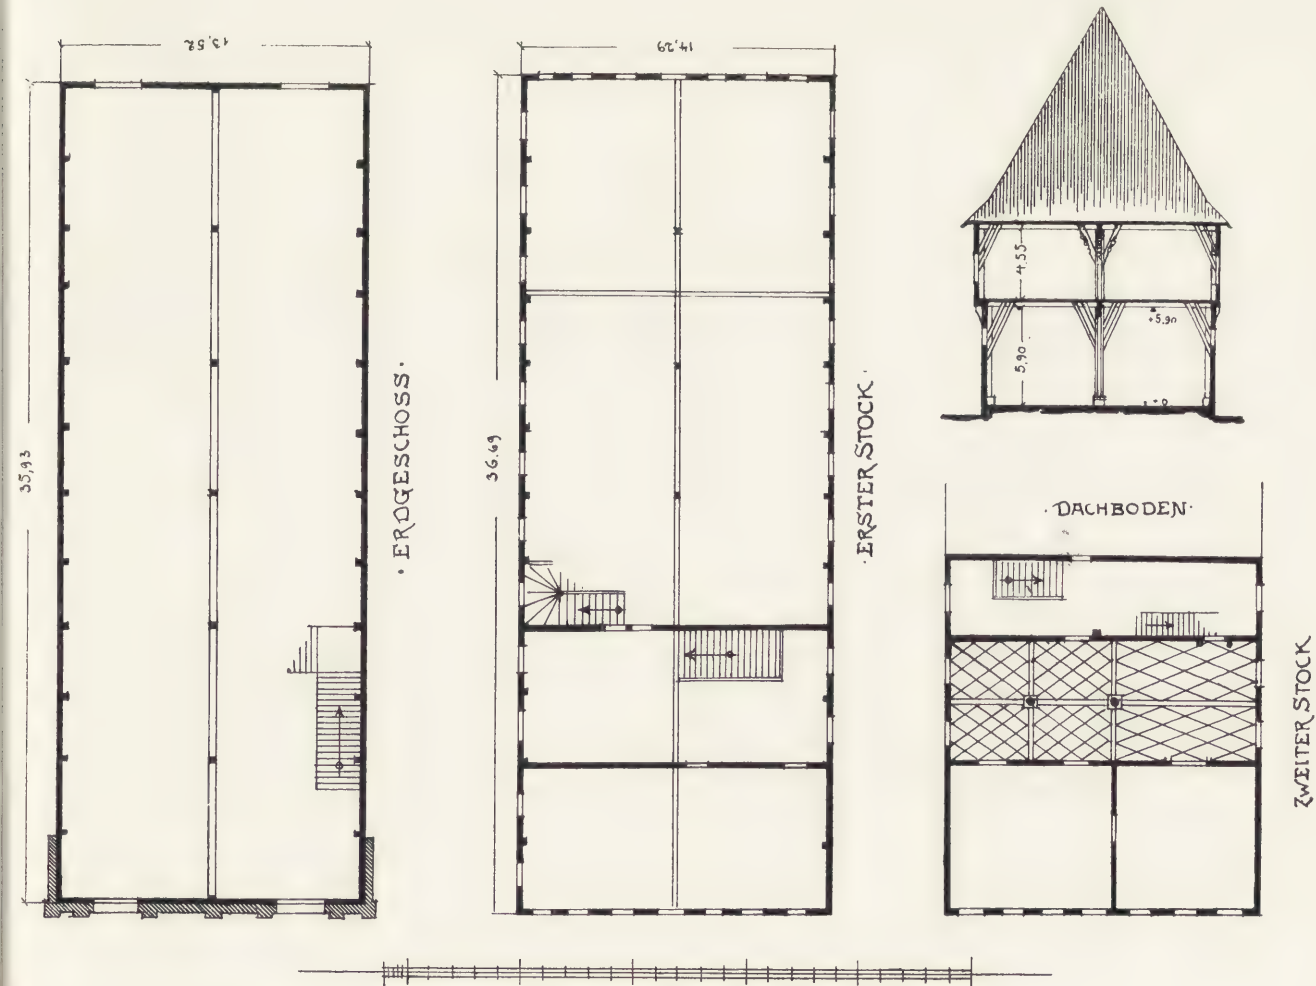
Rathaus zu Eßlingen. Grundrisse und Querschnitt des alten Baues.
